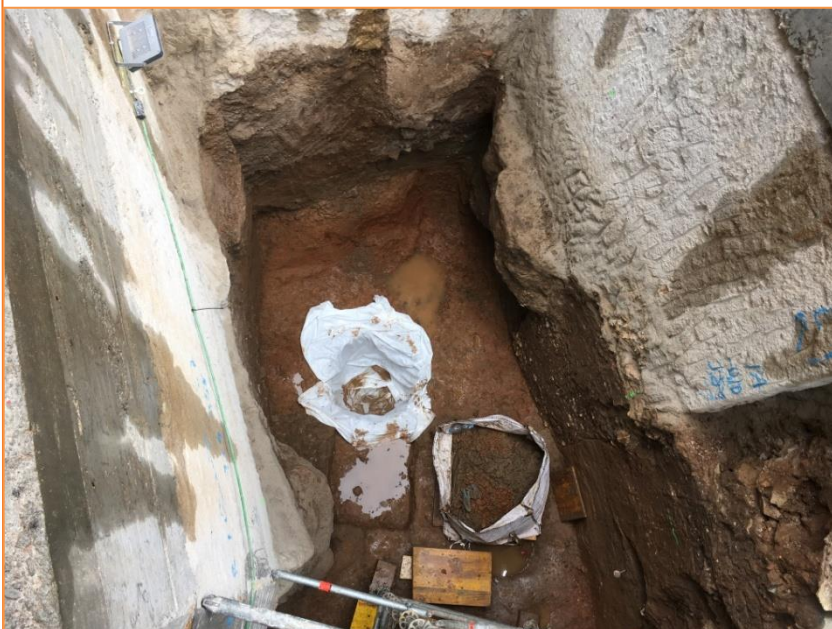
Vista de l'estat final de l'excavació de la zona de les escales.
